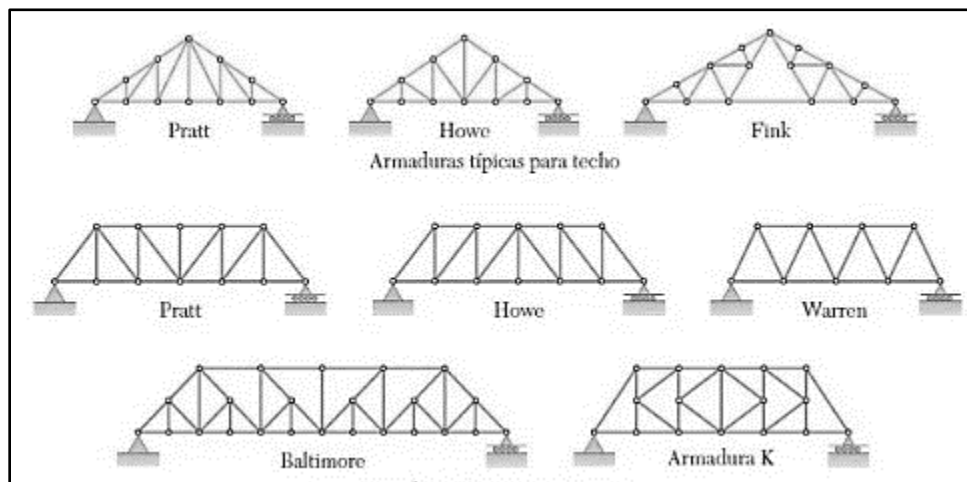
Tipos de armaduras (Meriam y Kraige, 2002).
